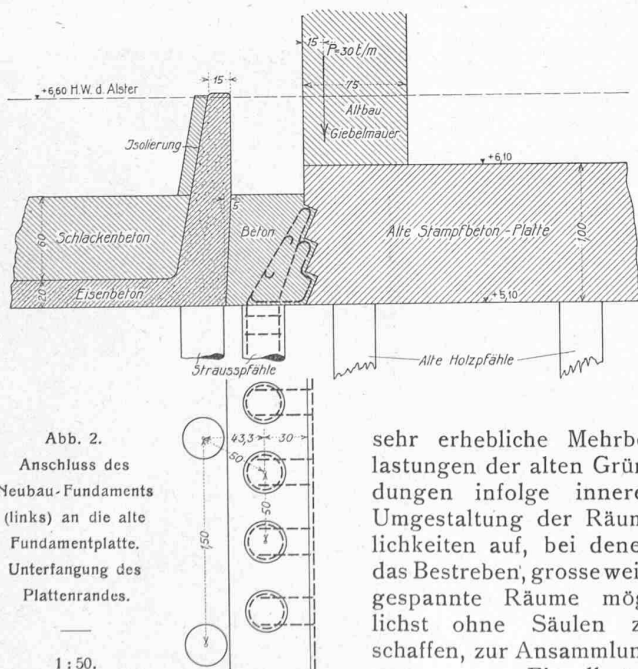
Anschluss des Neubau-Fundaments (links) an die alte Fundamentplatte. Unterfangung des Plattenrandes.
